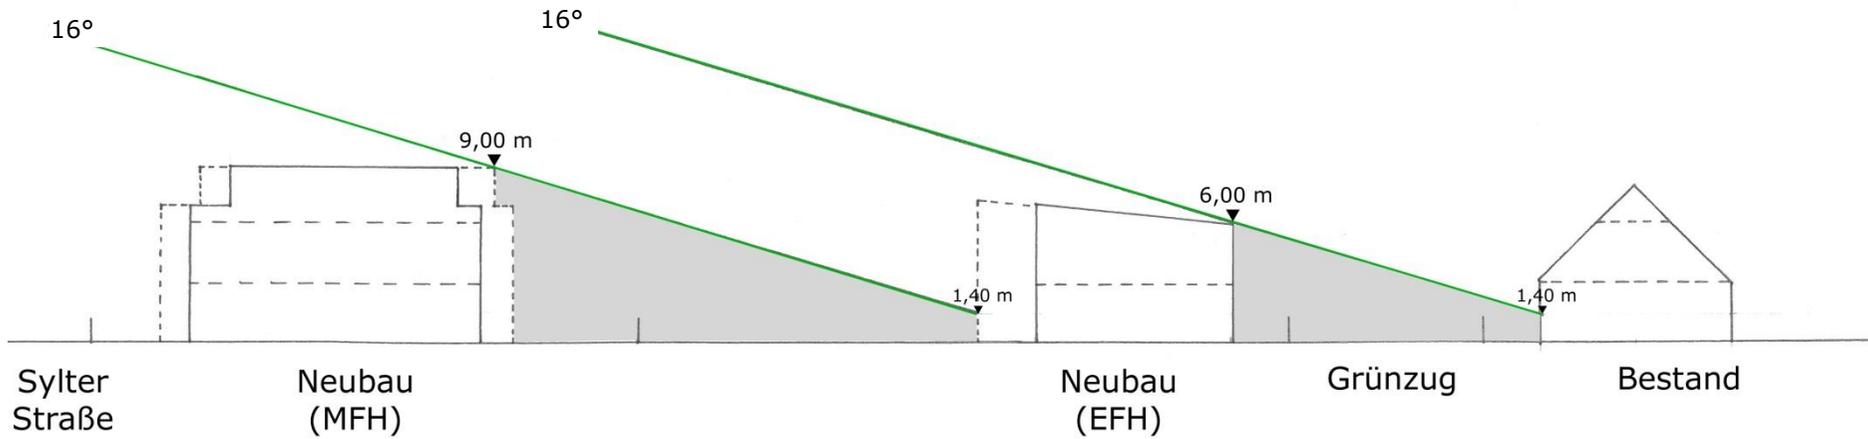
Sonnenstand für Schnitt B (Eigene Darstellung)
